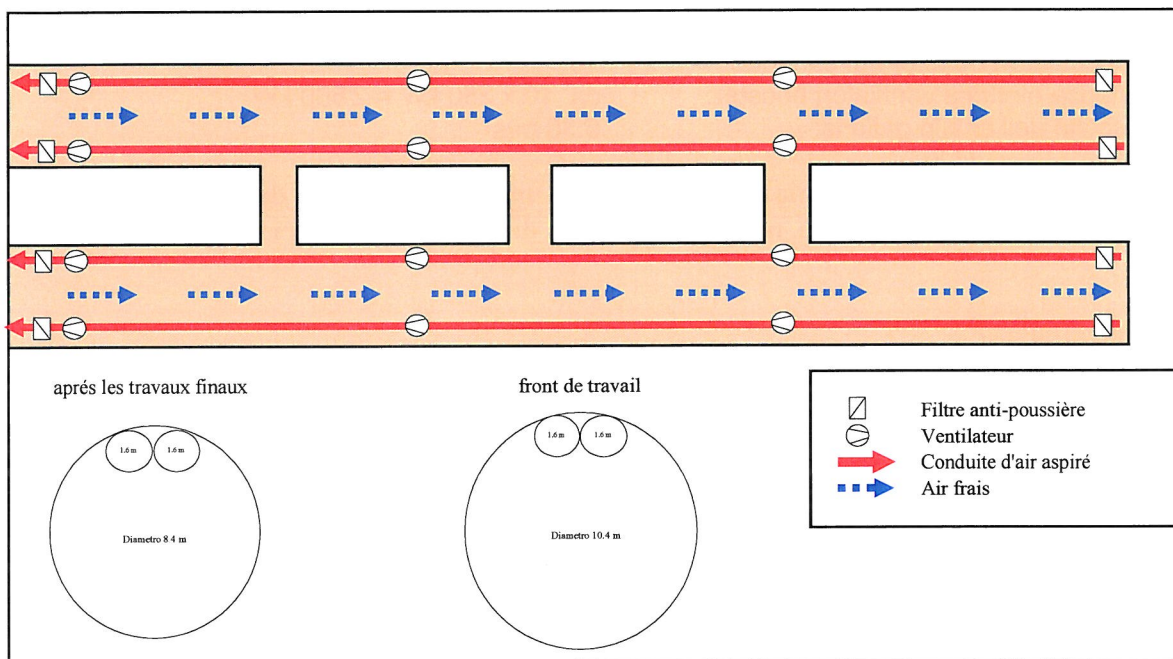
Schema della ventilazione del Tunnel di Interconnessione scavato dal portale ovest
